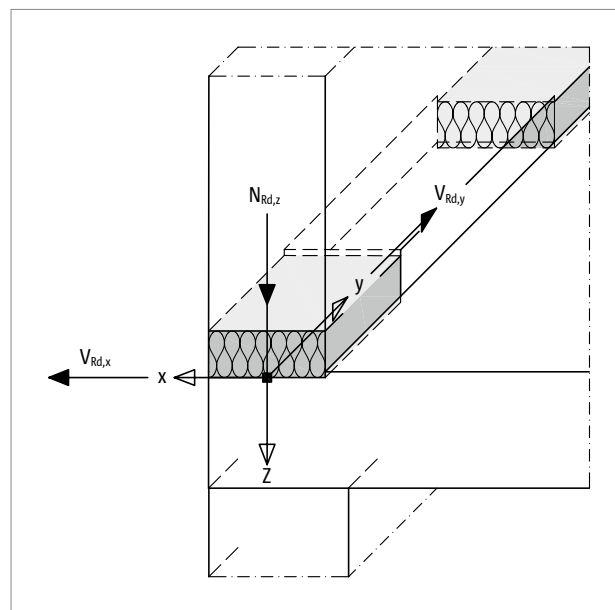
Schöck Sconnex® type W : convention des signes pour le dimensionnement
